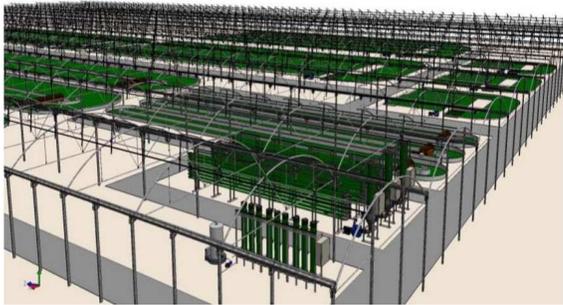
Vista de las instalaciones de 1 Has del Proyecto SABANA en fase constructiva final⁶
